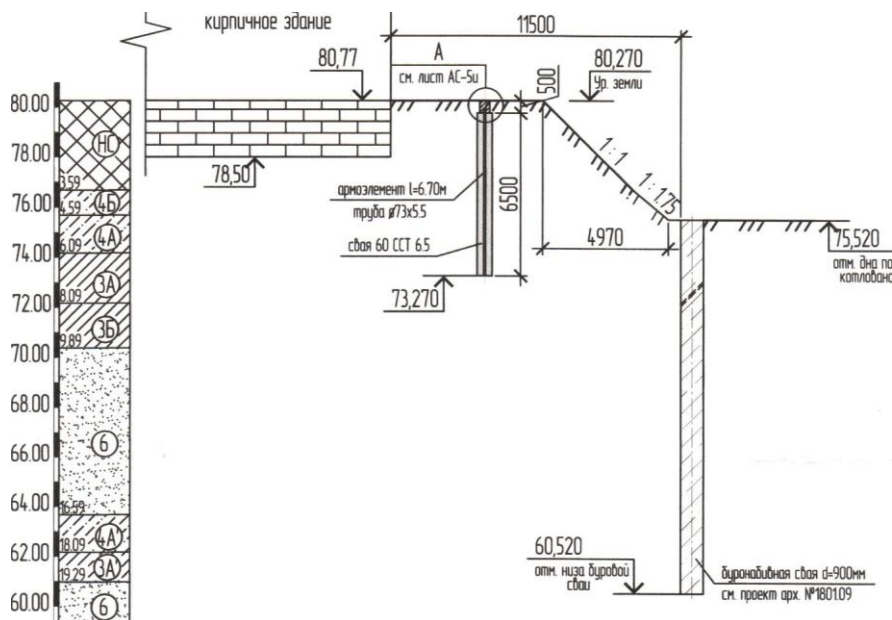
Общая конструктивная схема ограждения глубокого котлована системы «Стена в грунте», выполненной из двух рядов БНС, включая отсекающую и основную стену с грунтовыми анкерами
